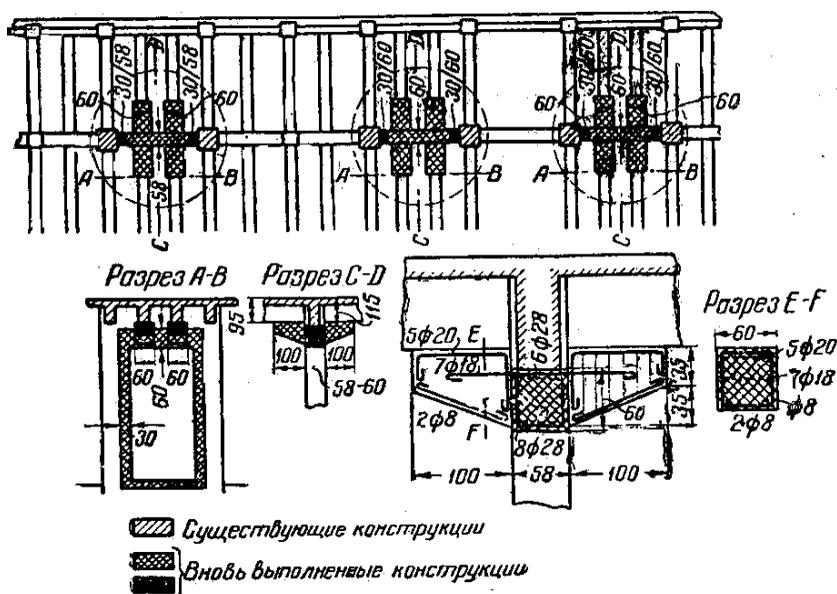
Применение железобетонных разгружающих конструкций для усиления междуэтажного перекрытия цеха завода в Венгрии
